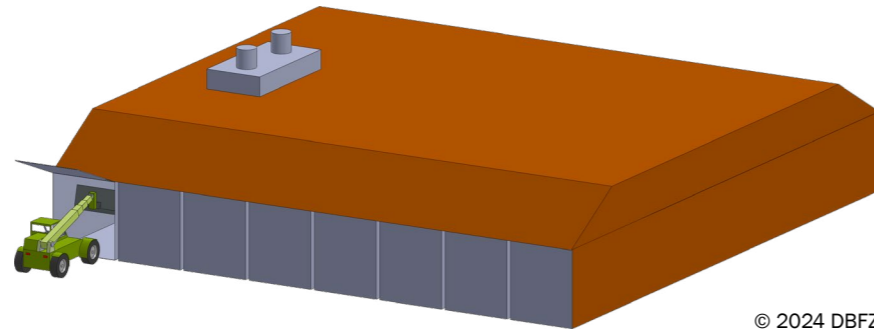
Garagenfermenter mit teleskopladergestütztem Substrat-, Gärmedium- und Gärrestumschlag
